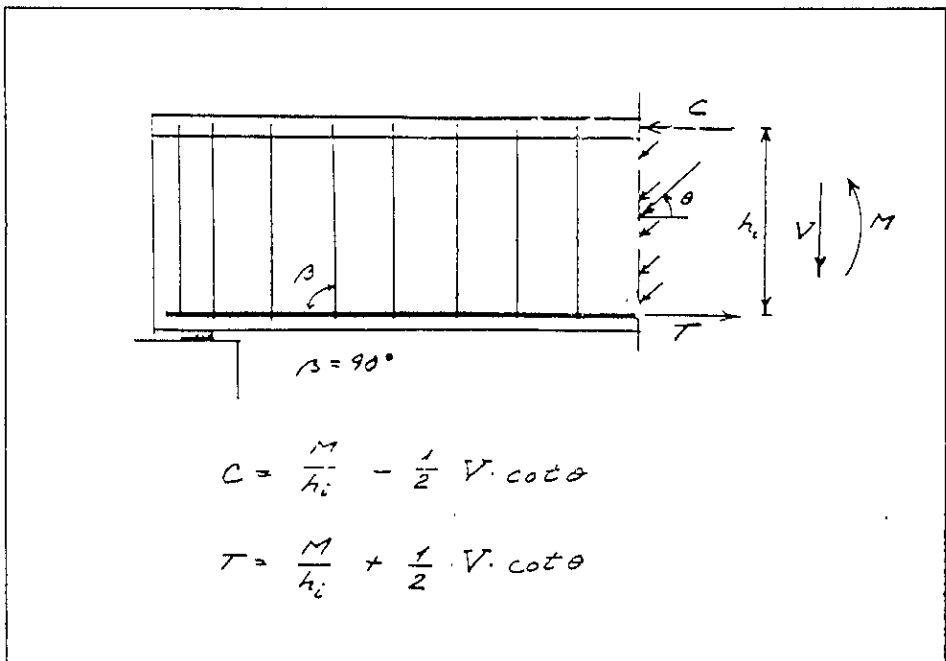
Fuerzas en cuerdas de tensión y compresión
